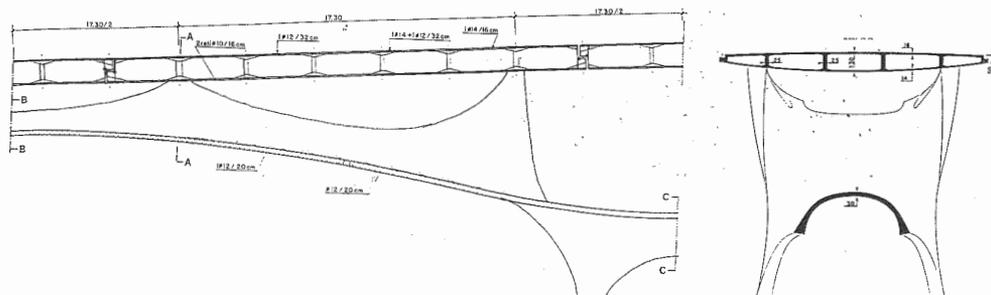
Sezione strutturale longitudinale e trasversale per il ponte sul Basento [3].
